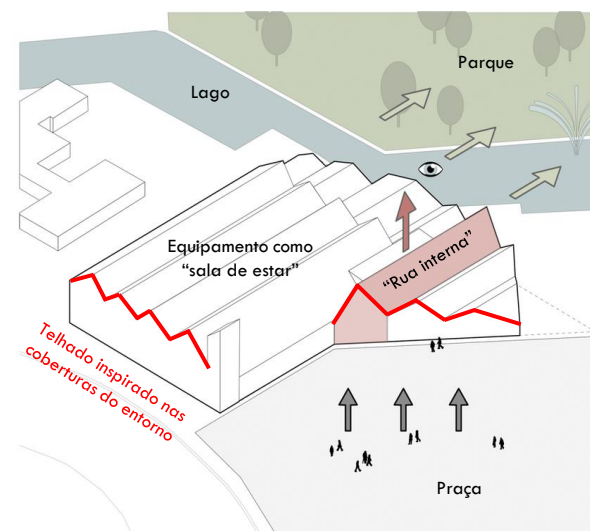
Esquema demonstrando a ligação entre o parque, o equipamento como “sala de estar” e a praça.
